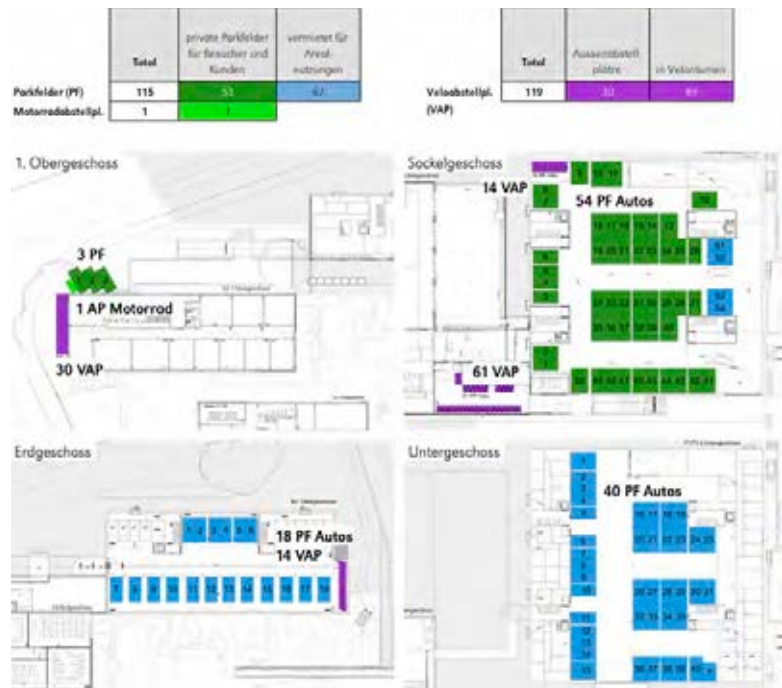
Anzahl und Lage der bestehenden Abstellplätze (vgl. Beilage B2)
